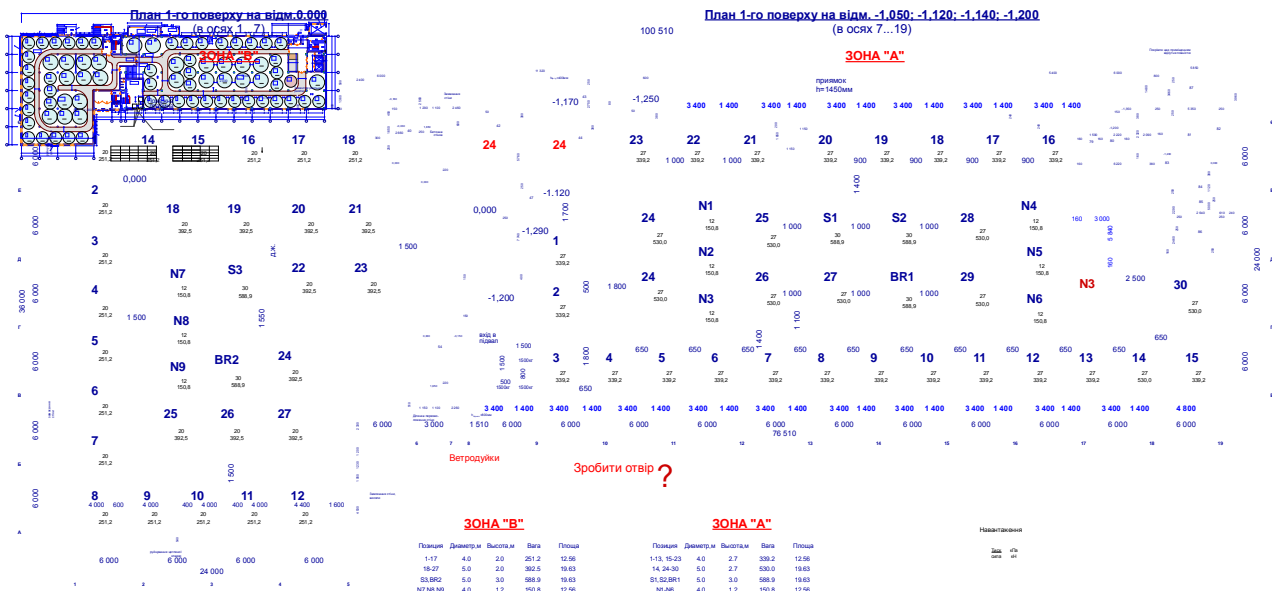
Розміщення технологічних ємностей на перекриттях будівлі
